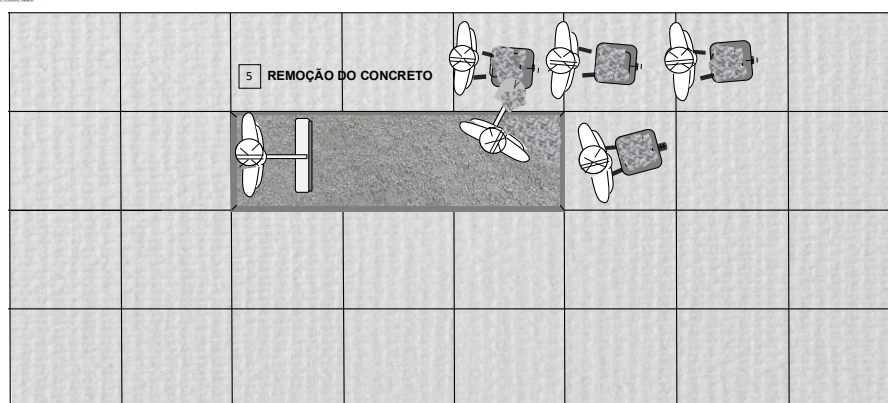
Remoção do concreto deteriorado e limpeza da caixa de escavação.
